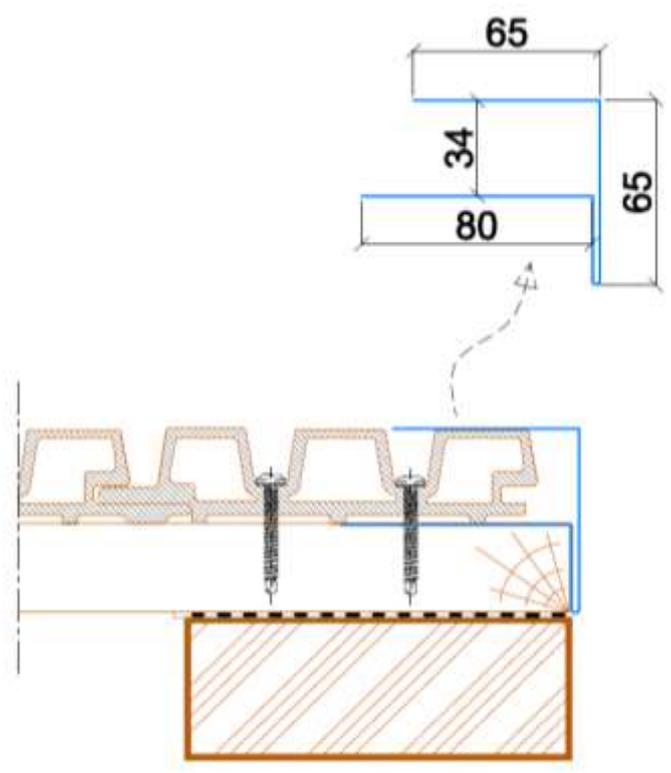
Coupe horizontale sur arrêt latéral sur OB en pose verticale
